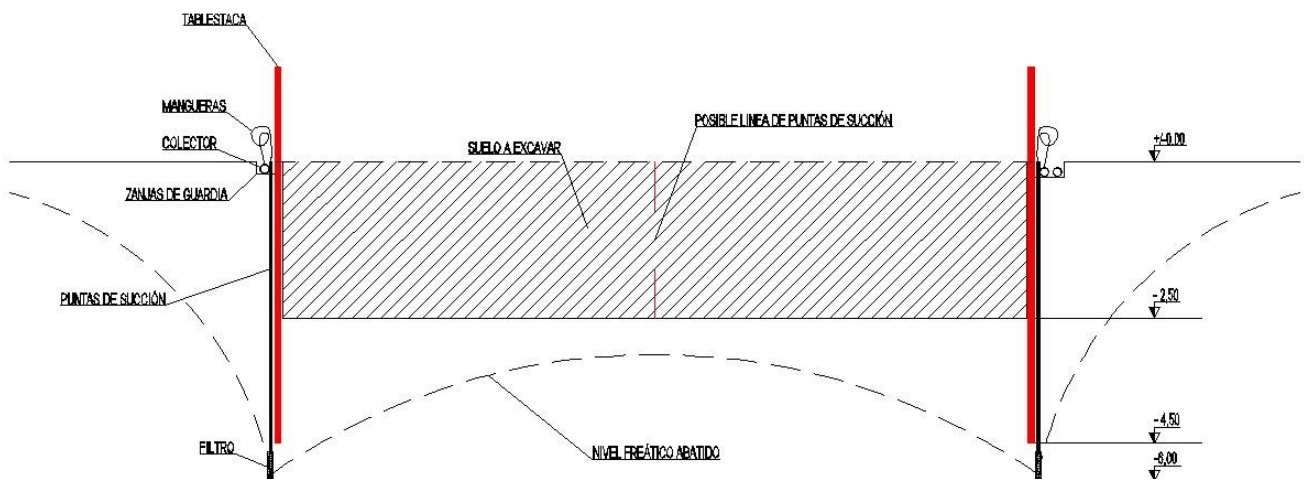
Esquema transversal de proceso constructivo.
